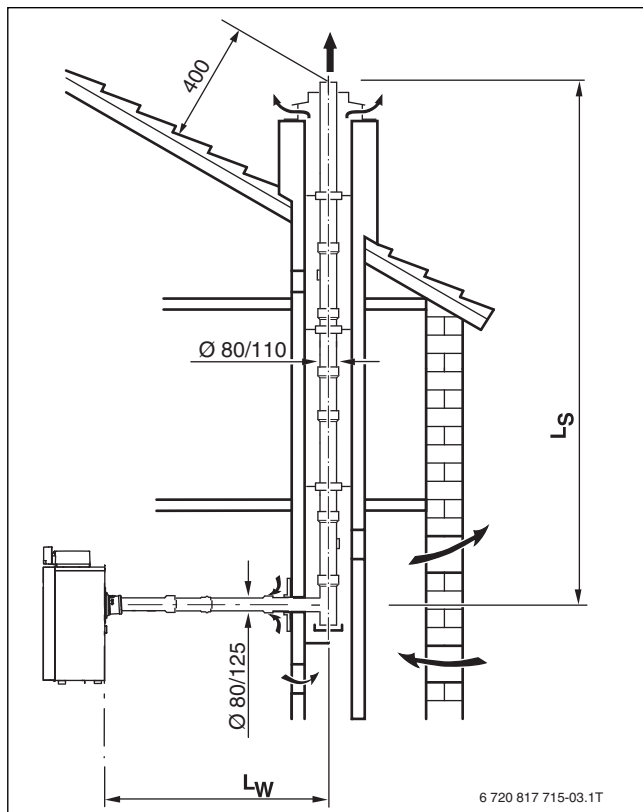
Conducción por tubo individual en la chimenea, rígido (B<sub>33</sub>, rígido)
